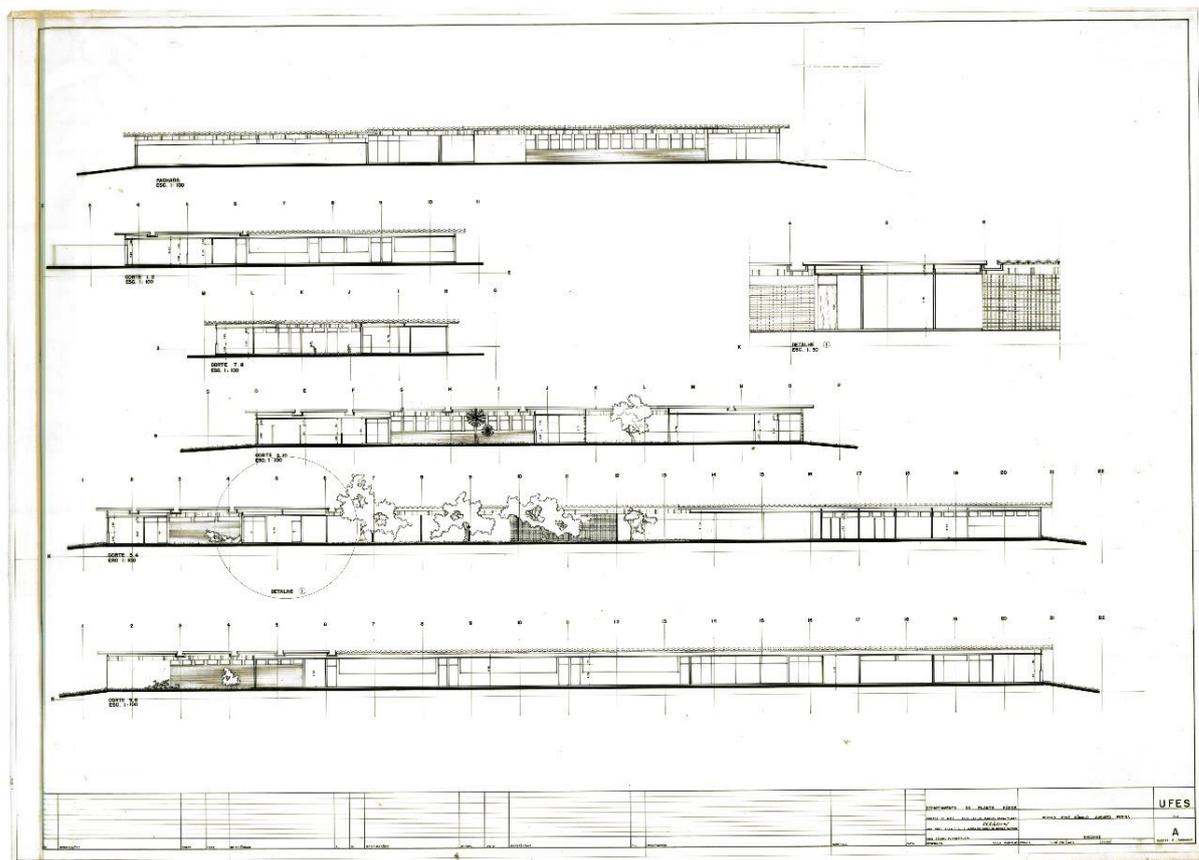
Fachada principal e cortes do bloco Creche, proposta de junho de 1982.
